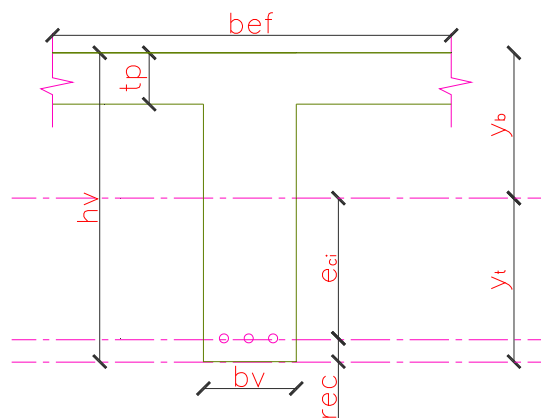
SECCIONES DE LA VIGA PARA PREESFUERZO. FUENTE: PROPIA
